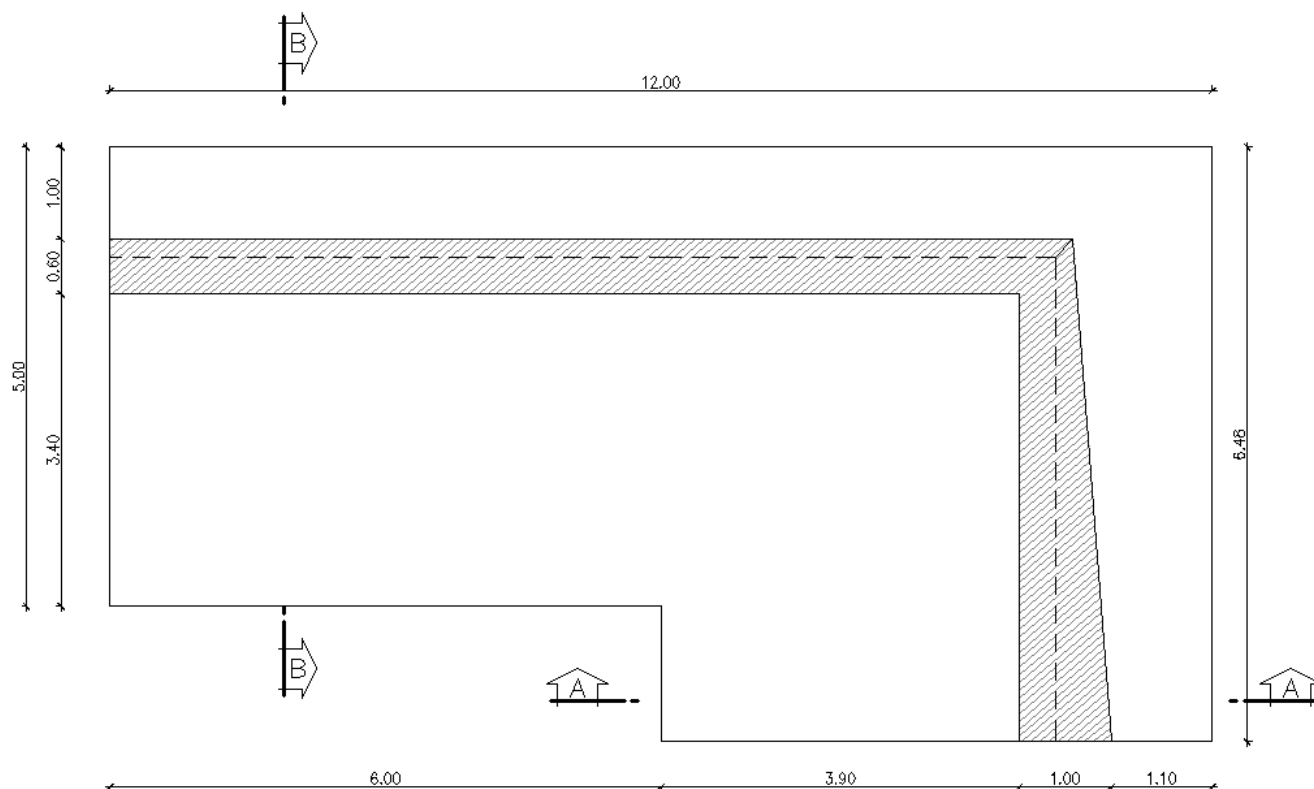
Pianta allo spiccato muro tipo A e muro tipo B
